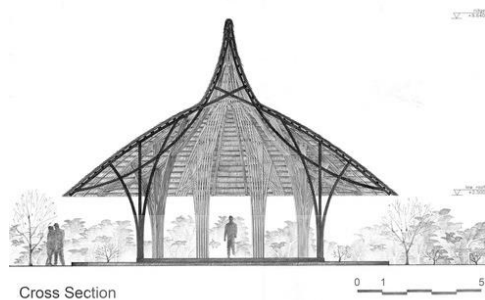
Perspektif Long Bamboo House Restaurant
